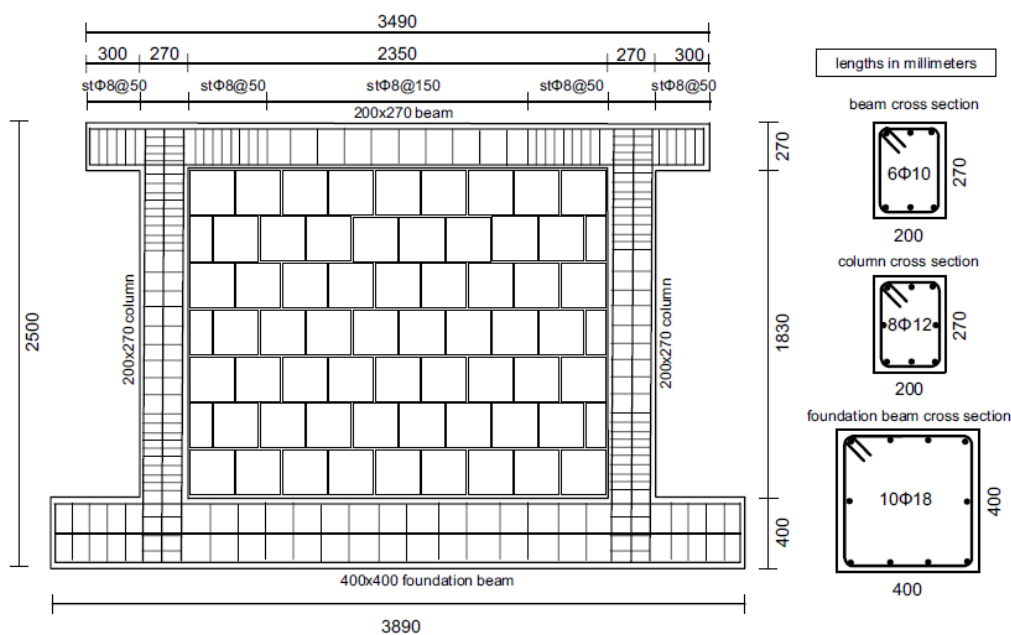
Geometria del sistema telaio-pannello e dettaglio delle armature di travi e pilastri.
